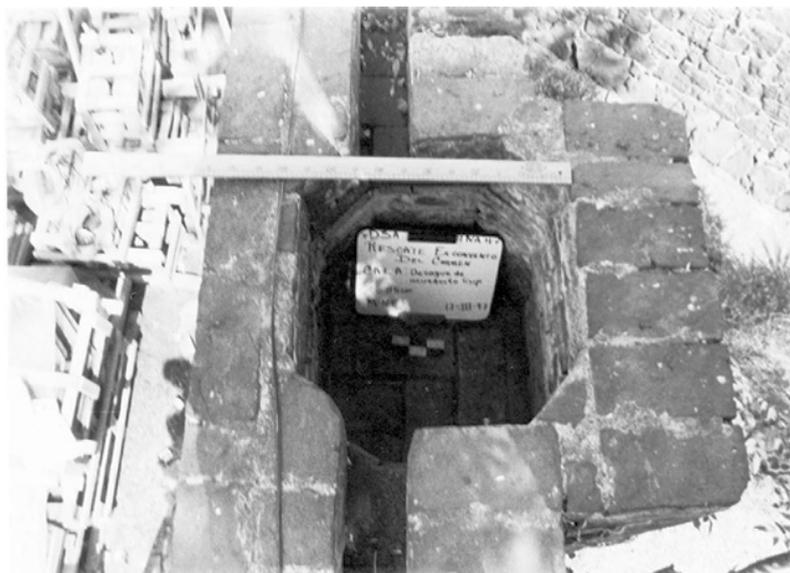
Detalle de areneros construidos en el acueducto, María de la Luz
